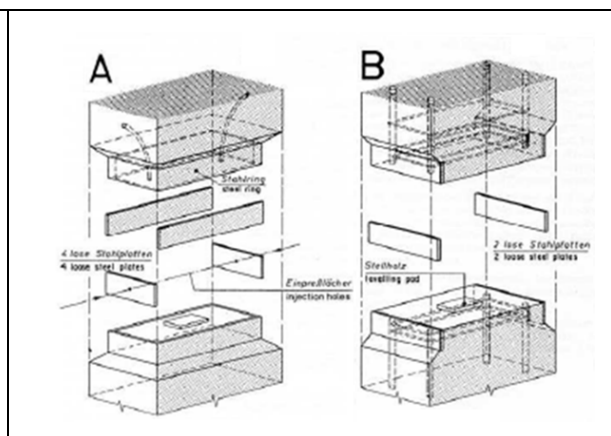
Ligação por soldadura de chapas (Stupré, 1981)
